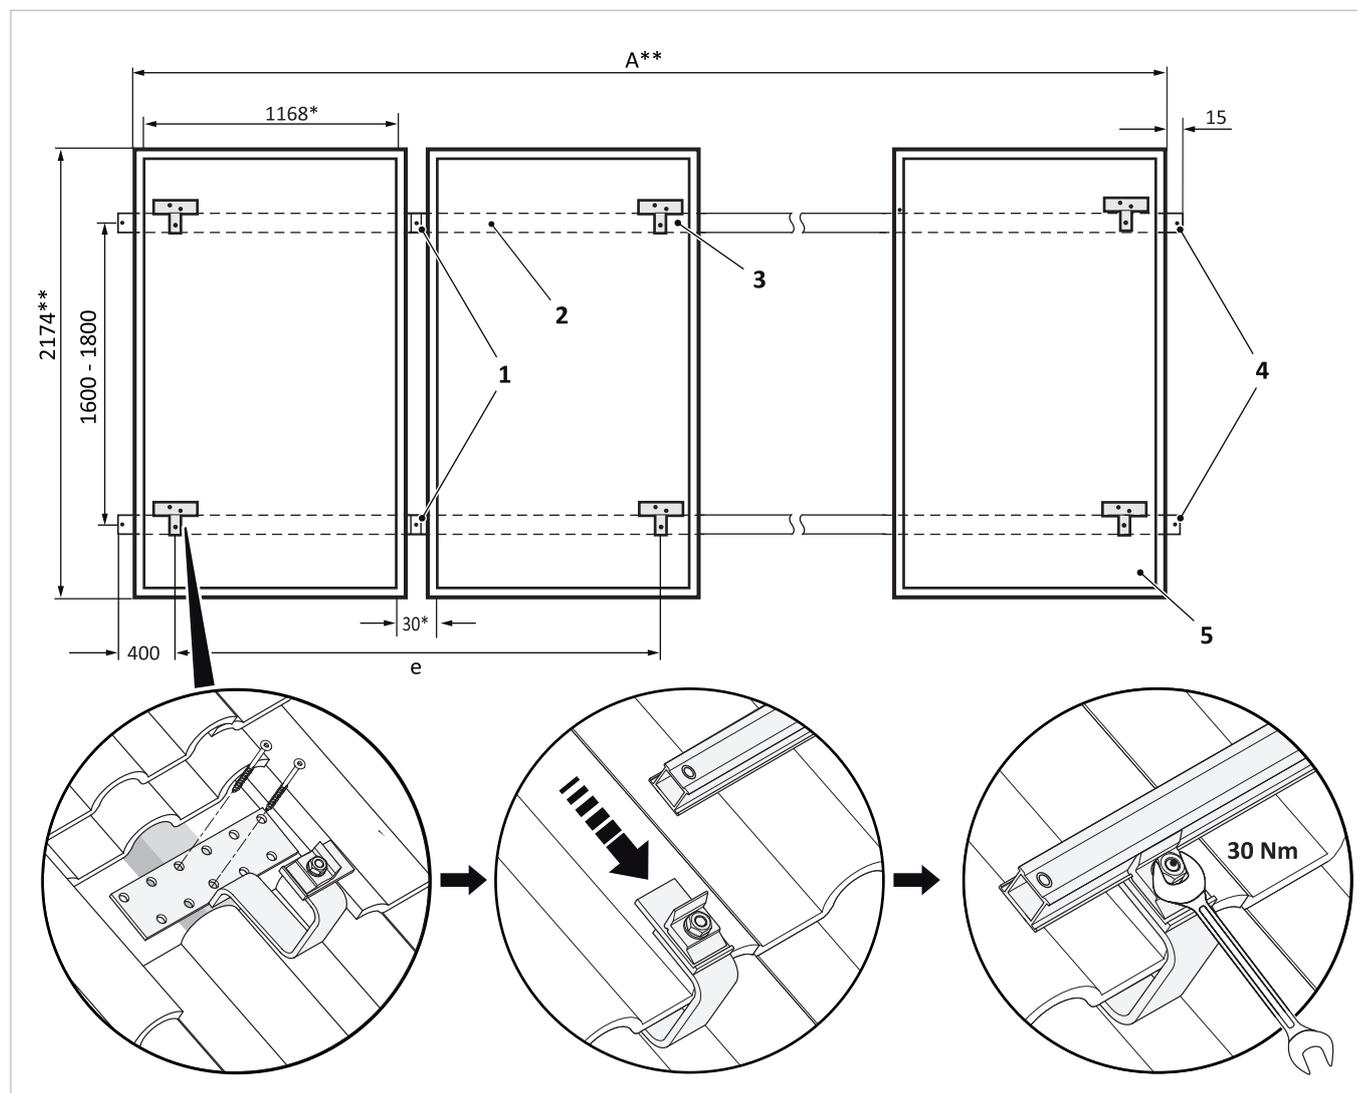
montaggio affiancato dei supporti per il tetto e delle guide di montaggio.
